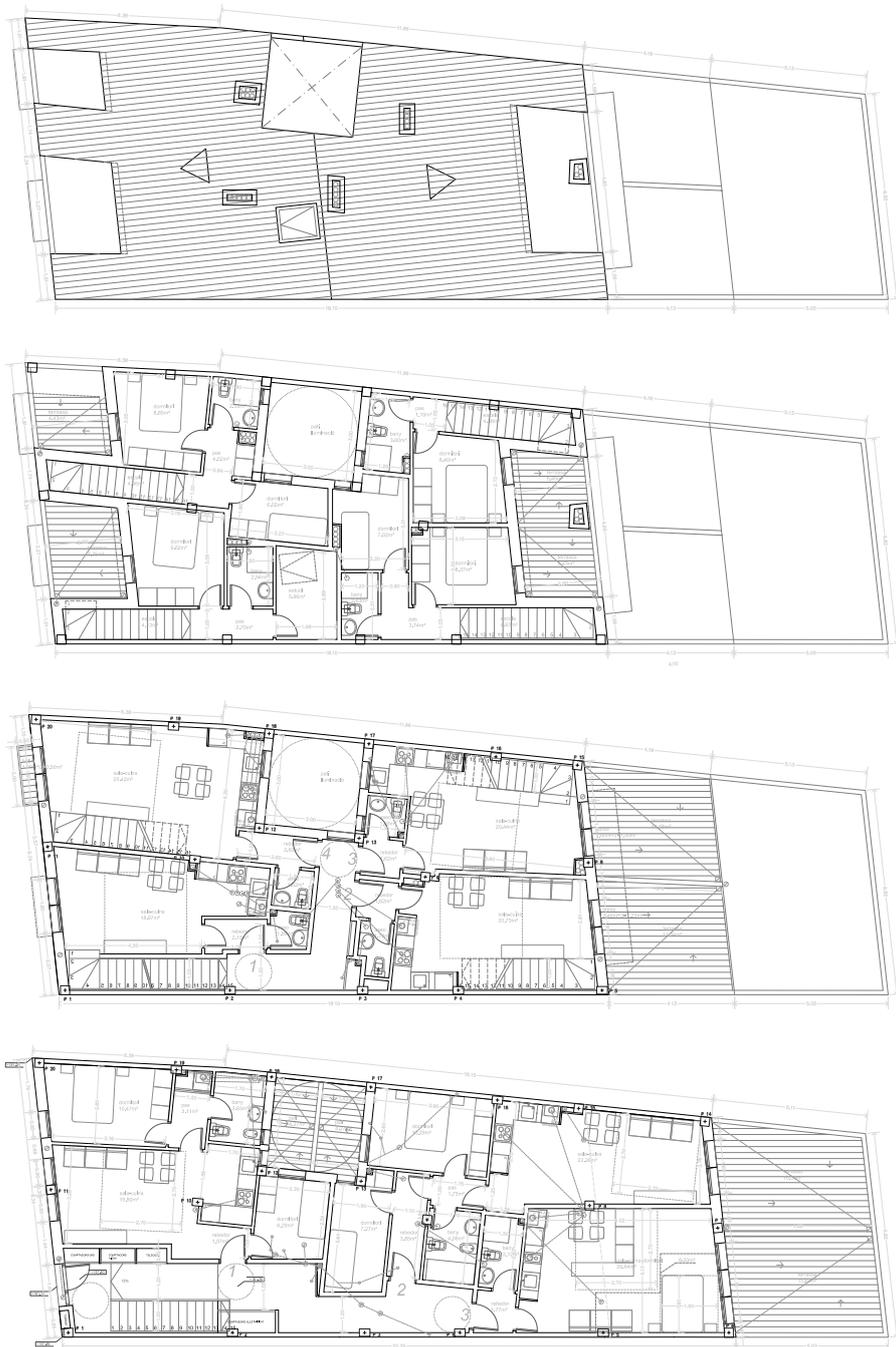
Edificio residencial. Plantas (Planta baja, Planta primera, Planta bajo cubierta, Cubierta)
